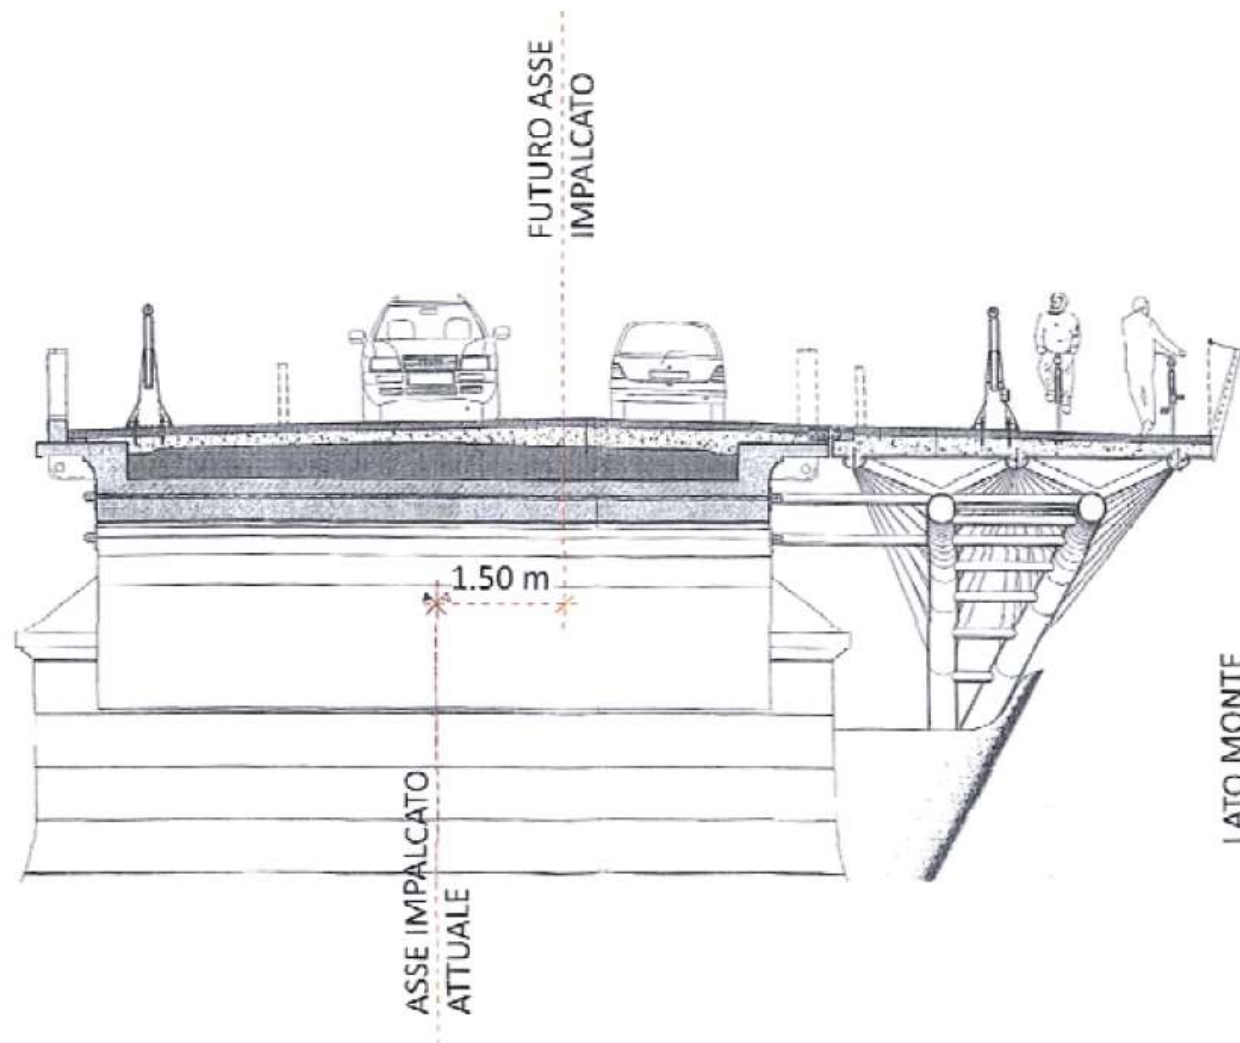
sezione tipo della soluzione prevista dall'Ing. Enzo Siviero
